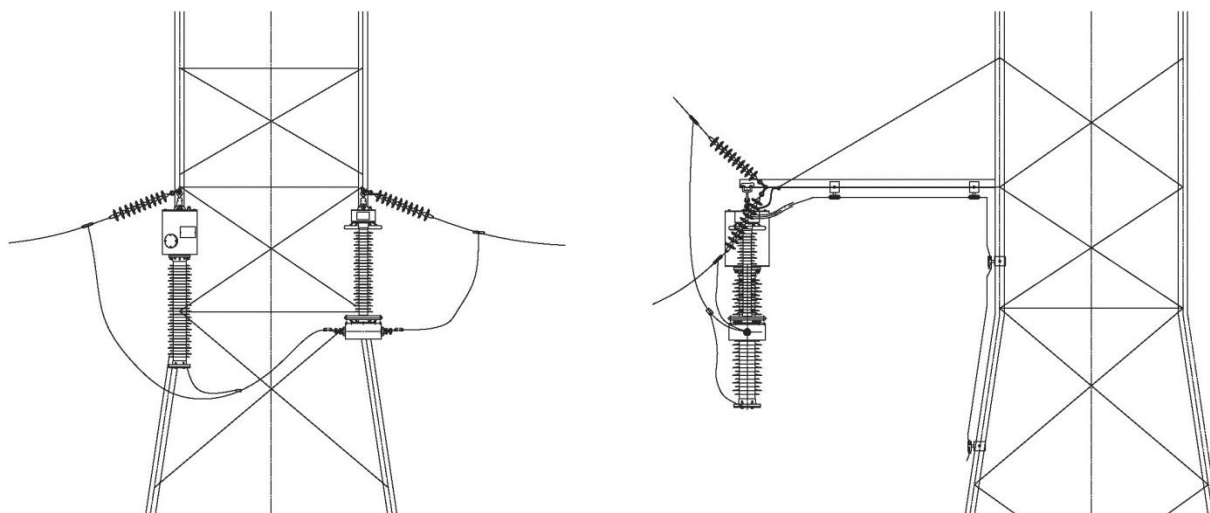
Подвеска устройств I-TOR и E-TOR на опоре ЛЭП.
